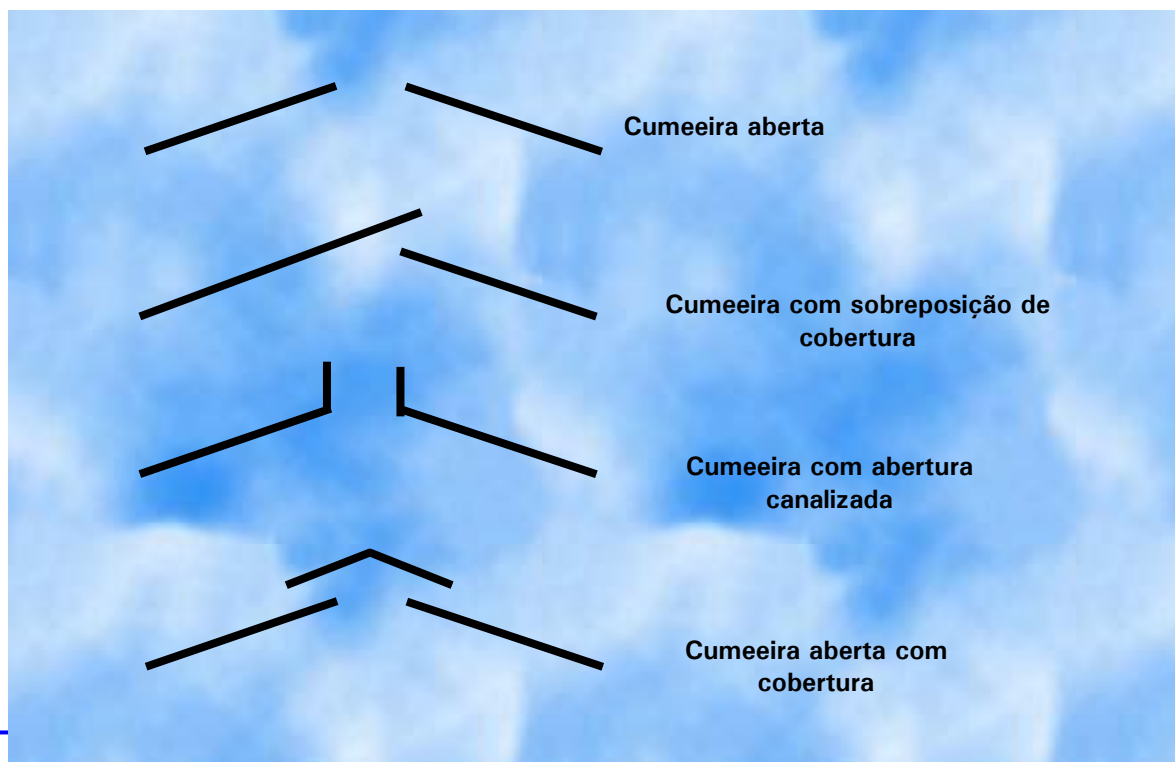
Tipos de abertura na cumeeira do telhado (Adaptado de Curtis, 1983).
